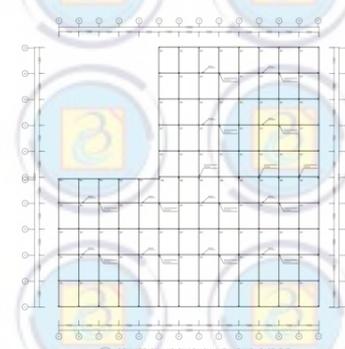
17. Denah Rencana Pondasi Bangunan Penunjang
